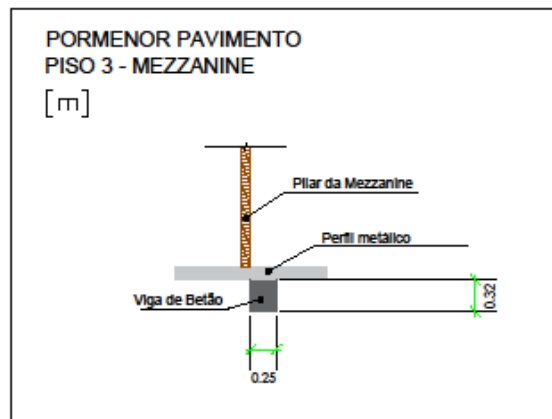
Pormenor do Pavimento do Piso 3 com a Mezzanine
